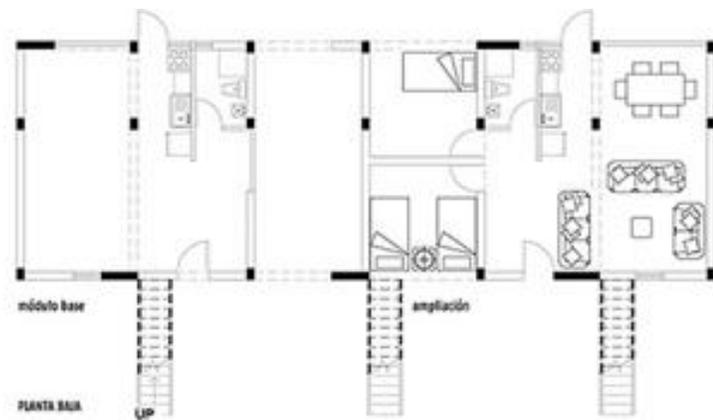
Planimetría de las viviendas. Las instalaciones sanitarias se encuentran todas ubicadas en la misma vertical para facilitar la bajante de las aguas, pero cada casa de forma independiente.
